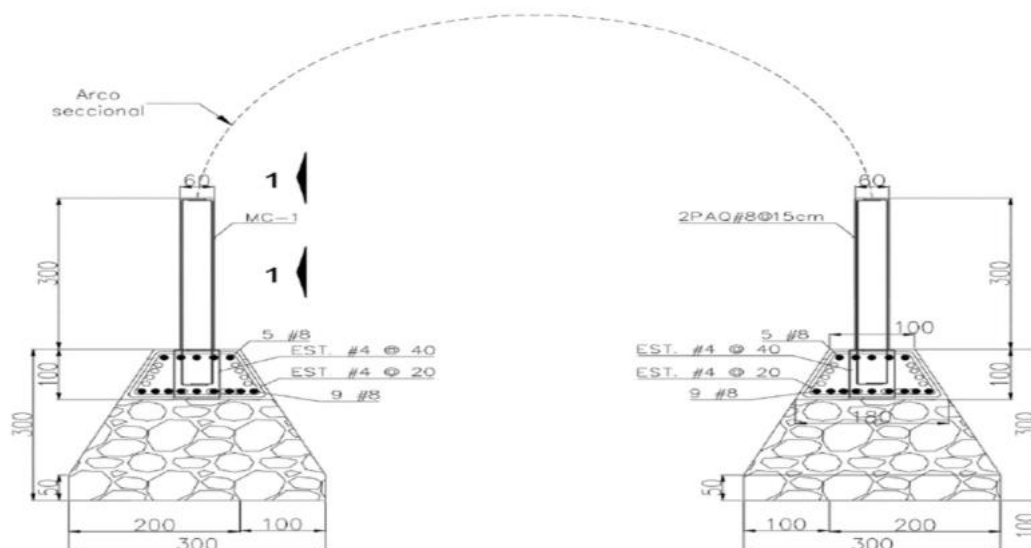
Sección transversal propuesta para las cajas de deflexión. Nota. Elaboración propia.
